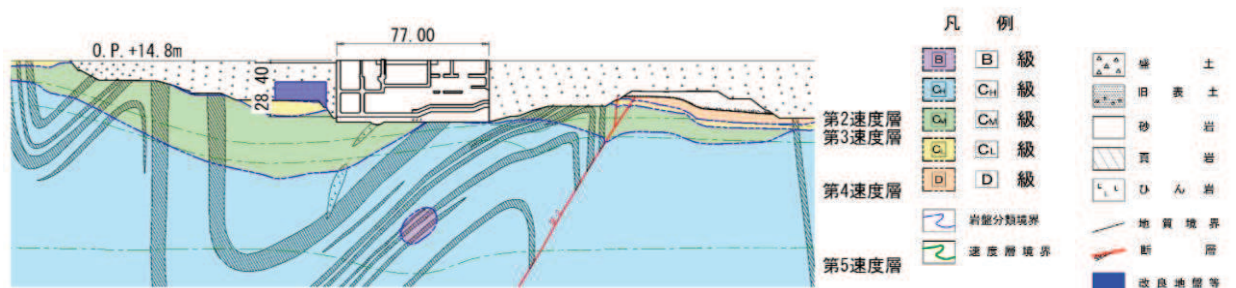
地盤改良体の配置図（海水ポンプ室縦断，D-D 断面）
